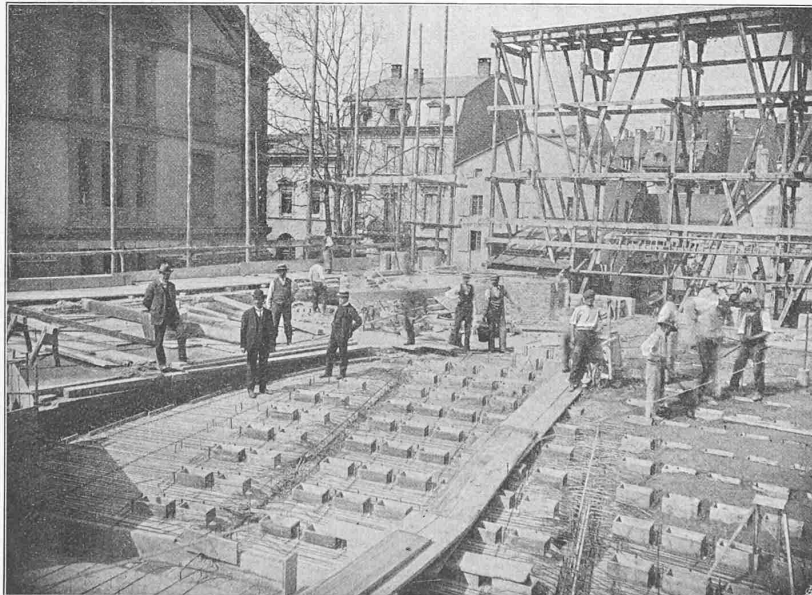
Blick auf den Parterrefussboden während der Betonierung.
